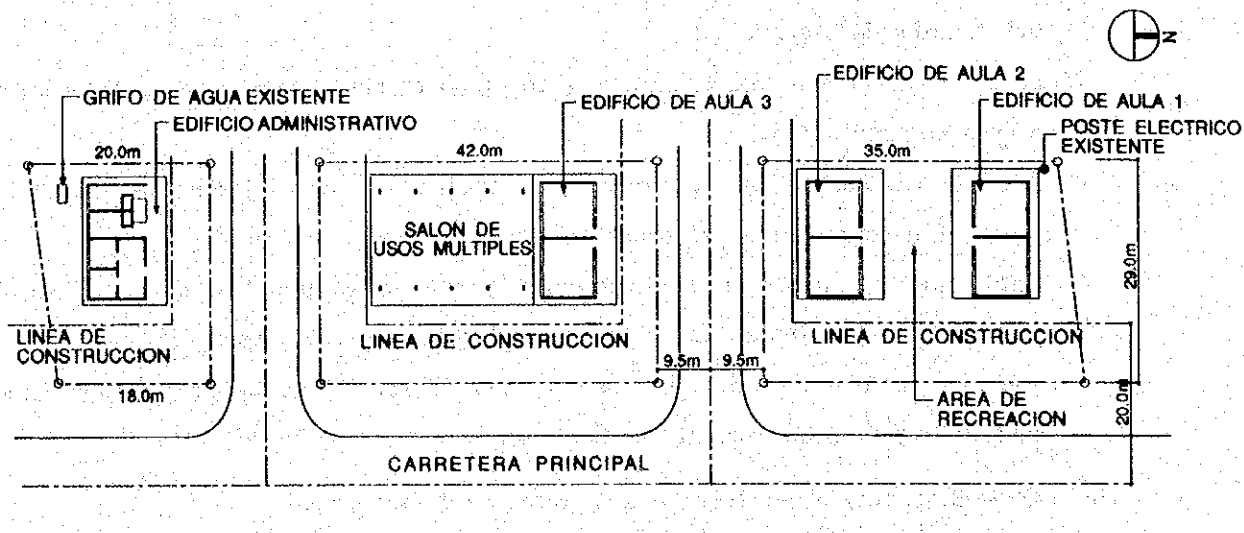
PLAN GENERAL DE DISPOSICION DEL INSTITUTO NACIONAL DE TEXISTEPEQUE
